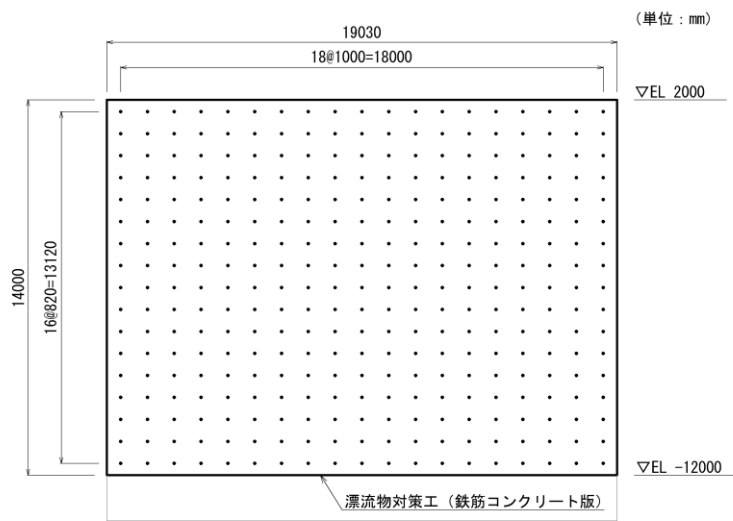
(3) 防波壁（波返重力擁壁）ケーソンにおける漂流物対策工（鉄筋コンクリート版）のアンカーボルト配置図（正面図）
